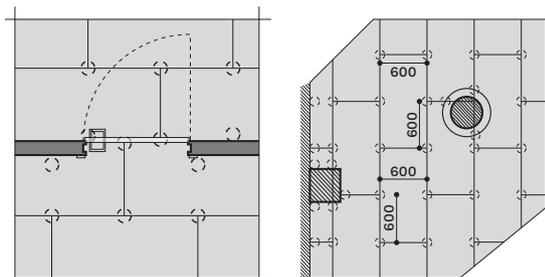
Schema nodo porto e schermo nodo raccordo pilastri e pavimento
